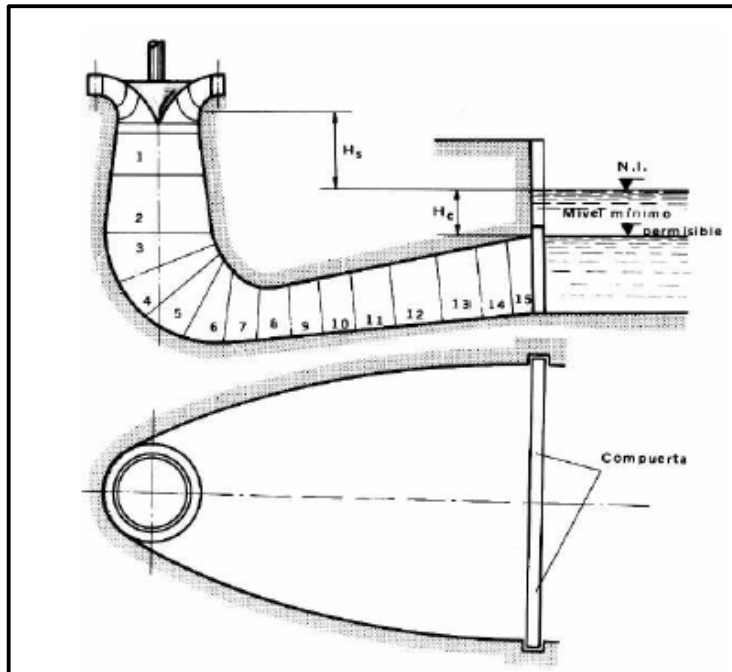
Alzado y planta del tubo de aspiración seleccionado con elevado rendimiento
